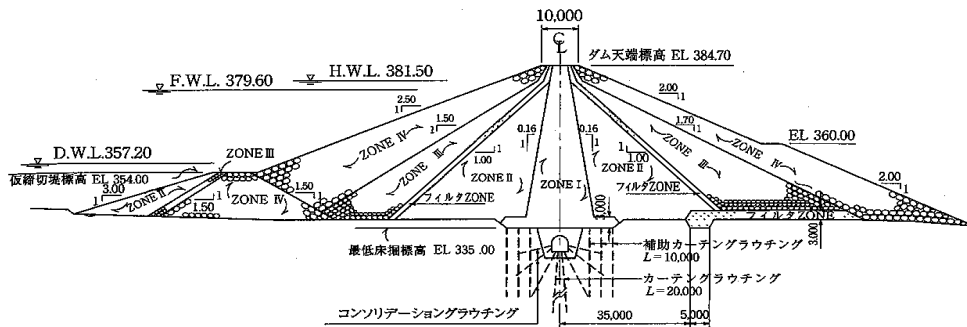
中心遮水ゾーン型フィルダムの事例（目谷ダム）
